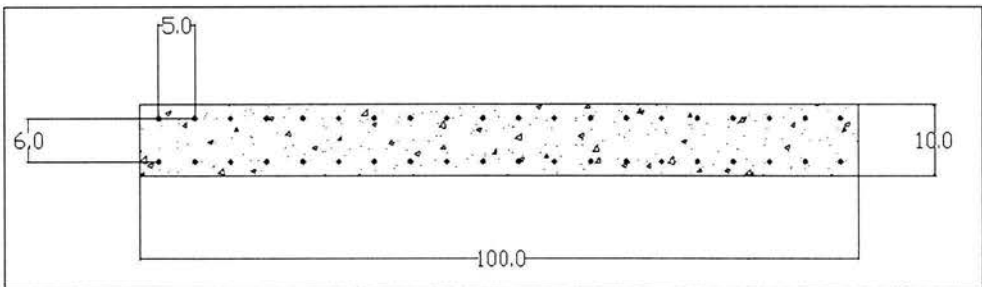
Sección transversal en mm para cálculo del módulo de elasticidad del concreto reforzado con Kevlar.
